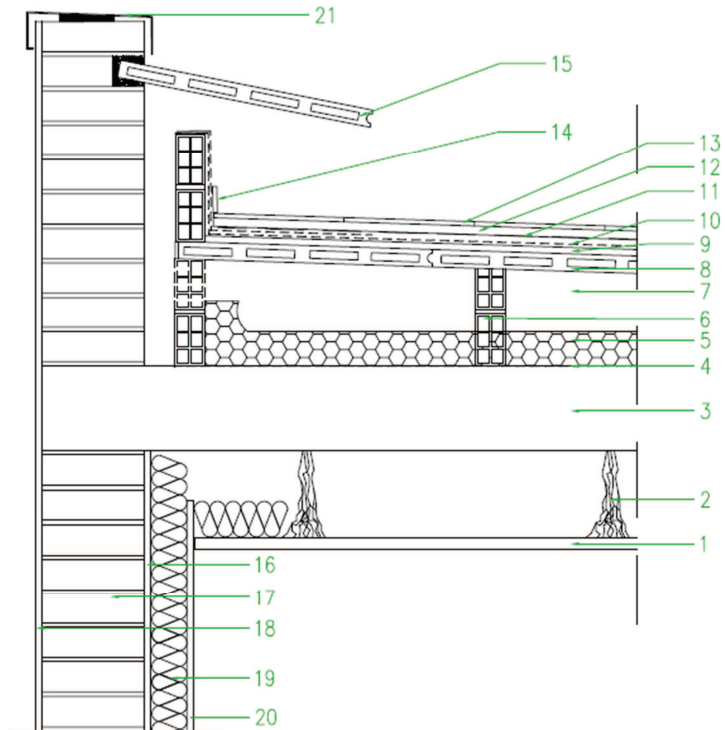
Detalle encuentro cubierta-fachada aislamiento por el interior
